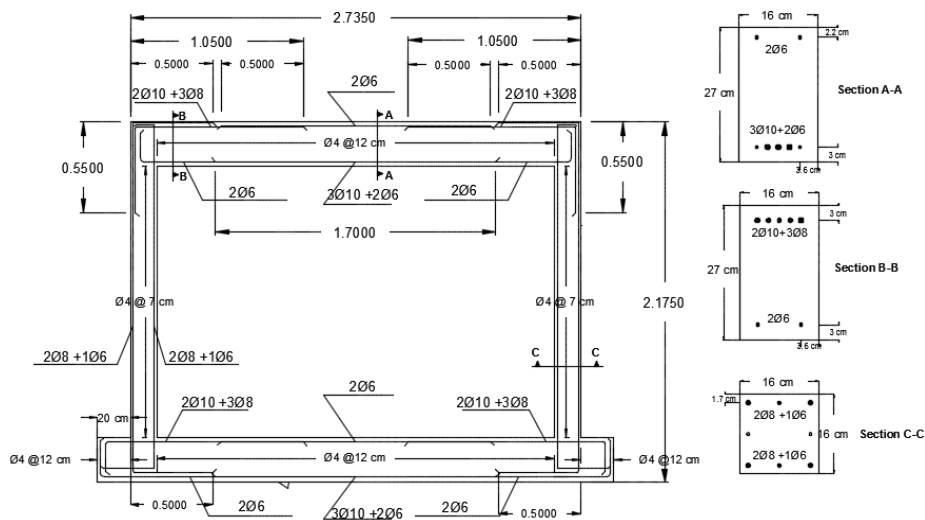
Geometria e esquema de armaduras no modelo reduzido do pórtico tipo adotado
